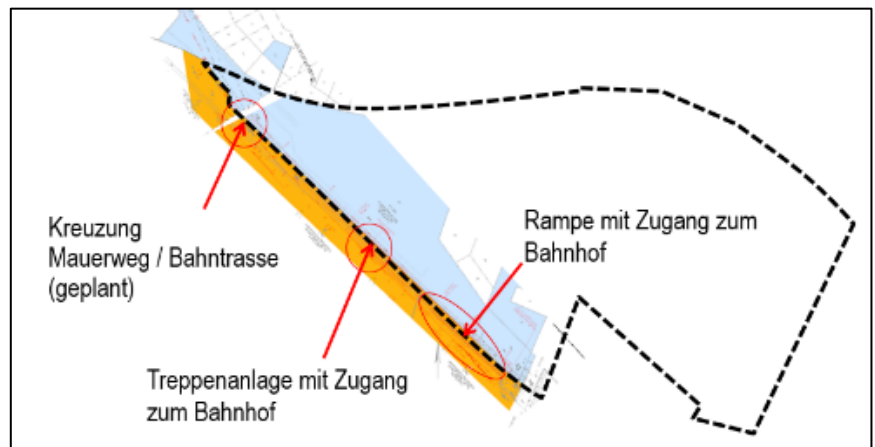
Lageplan NEB (07/2018) - mit Gebietsgrenze und Hinweisen
